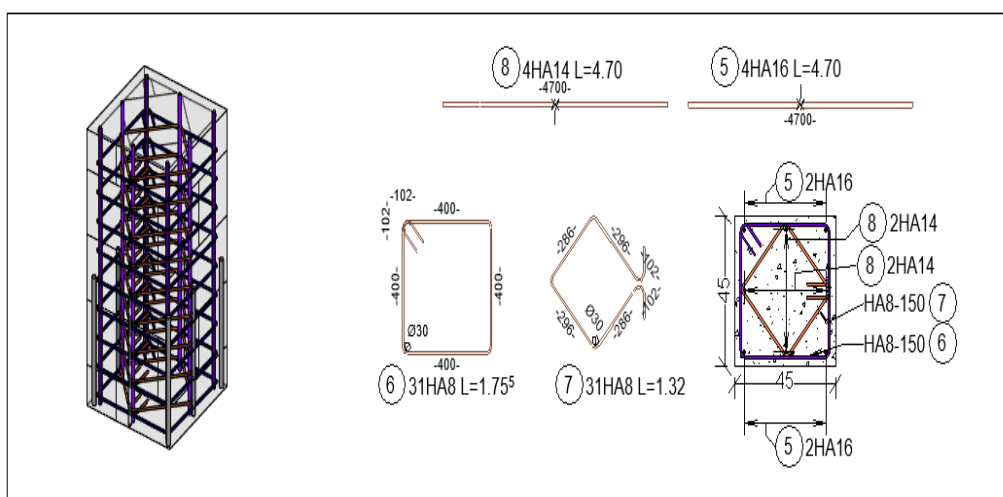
Schéma de ferrailage de poteaux (45*45).
